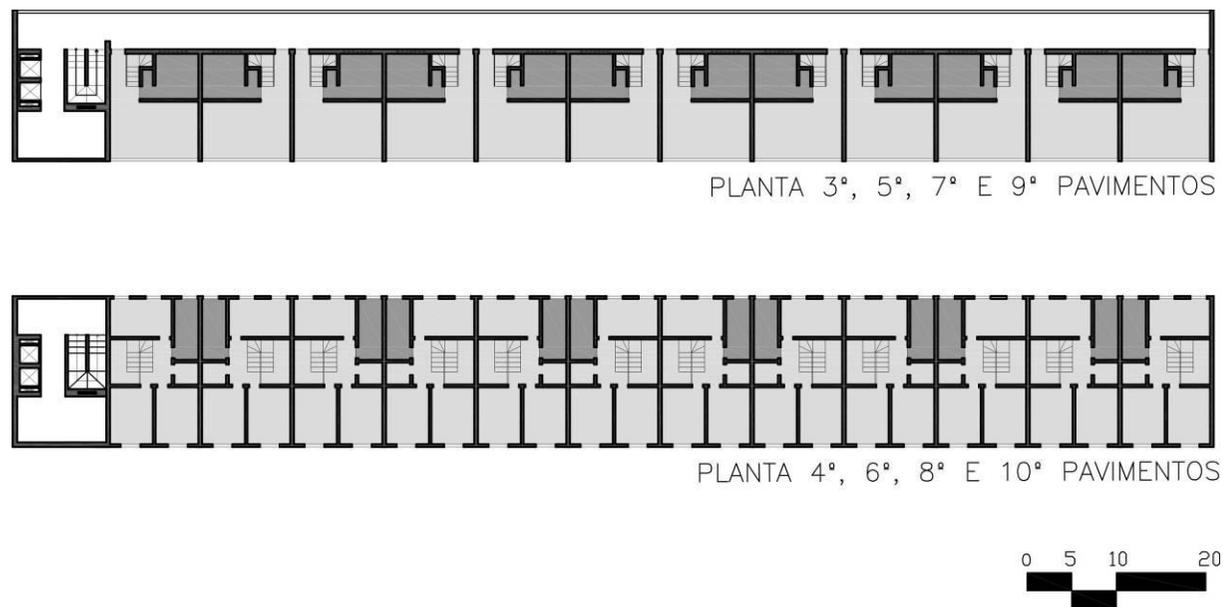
Conjunto Residencial Vila Isabel, Planta do bloco construído.
